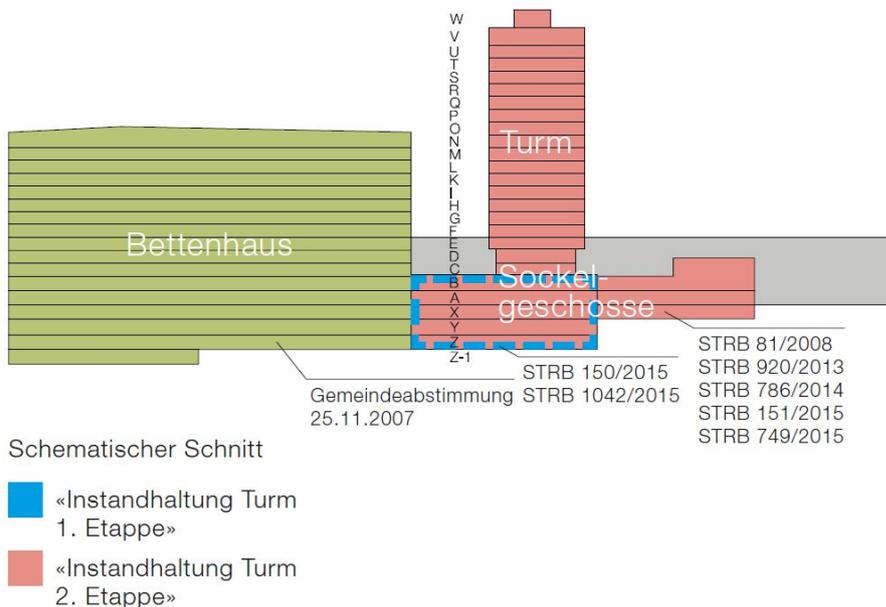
Abgrenzung der Etappen Instandhaltung Turm gemäss STRB Nr. 150/2015 und STRB Nr. 151/2015. Geschossbezeichnungen Neubau Bettenhaus und Turm (ehemals Hauptgebäude).
